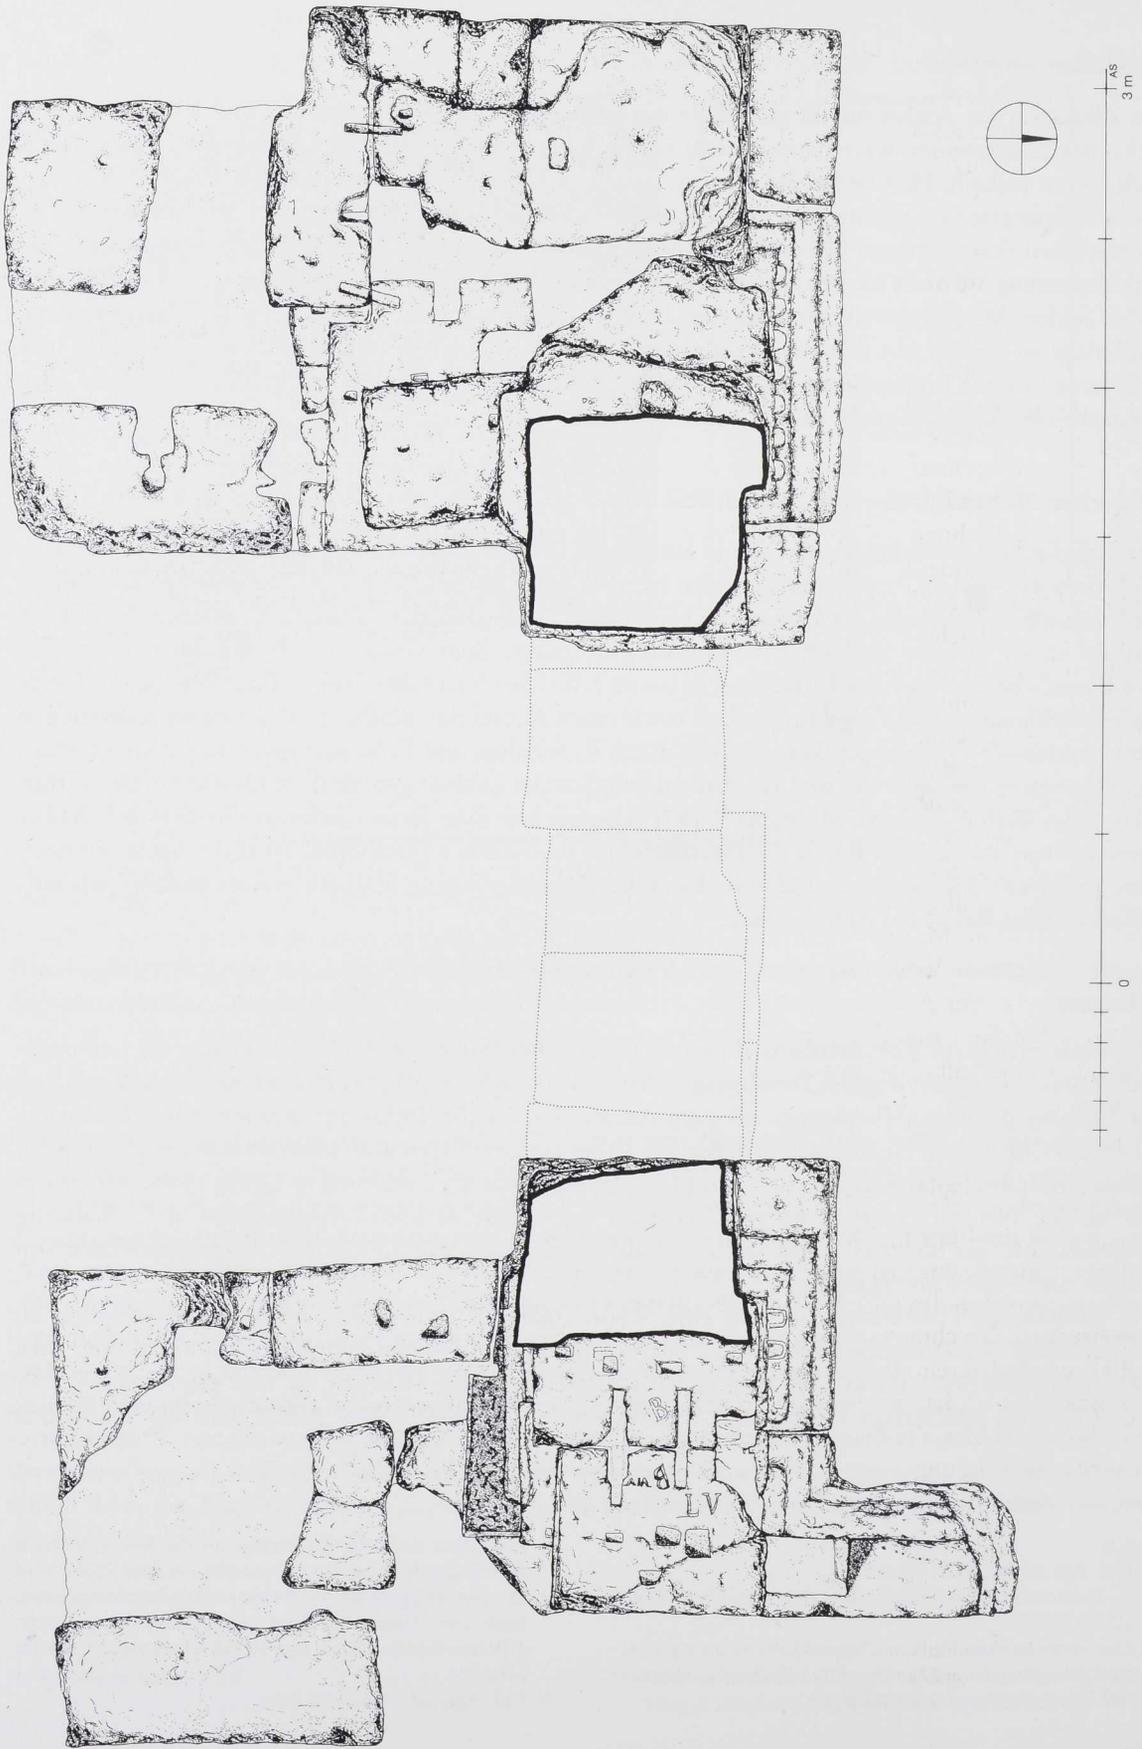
Östlicher Nebendurchgang. Grundriß des erhaltenen Baubestandes (Schnitthöhe 2,73 m). - M = 1:25.
